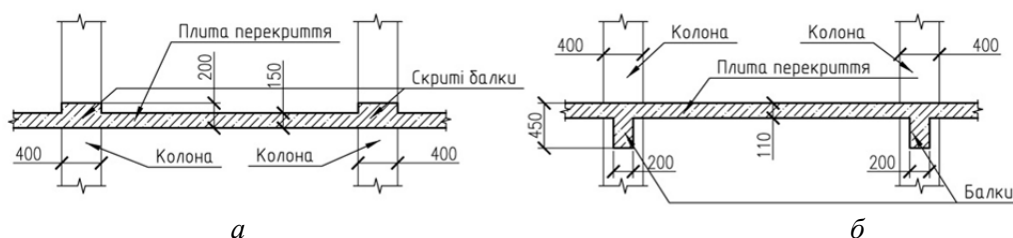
Варіанти конструктивного рішення монолітного перекриття житлової будівлі: а – плоске перекриття; б – ребристе перекриття
